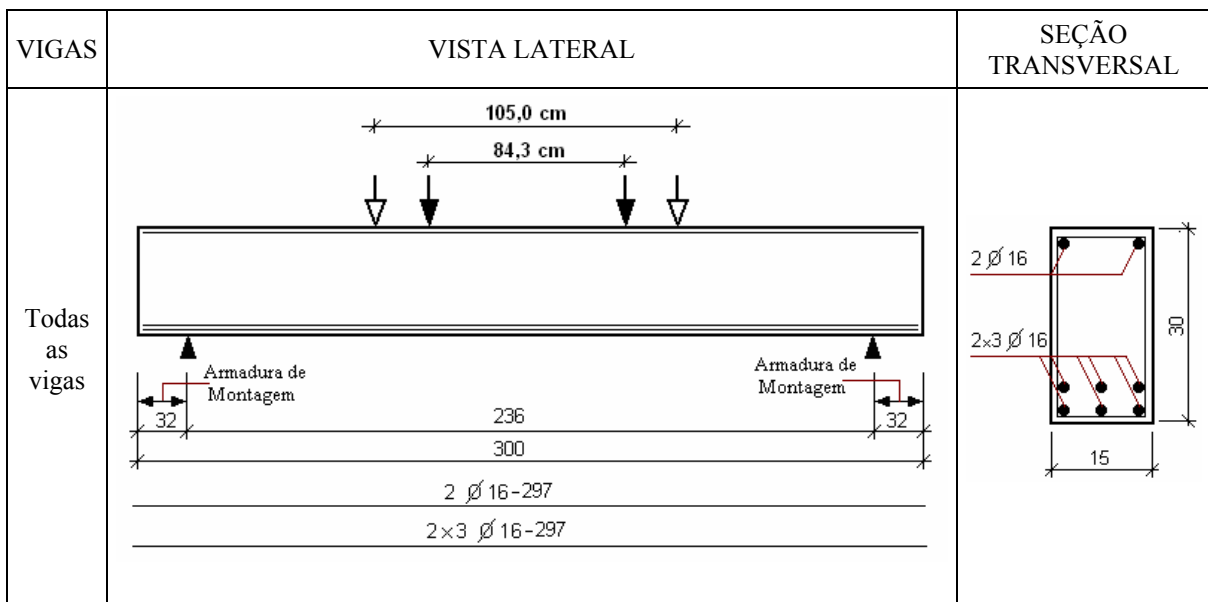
Armadura das vigas do Grupo C reforçadas ao cisalhamento (BEBER, 2003)
